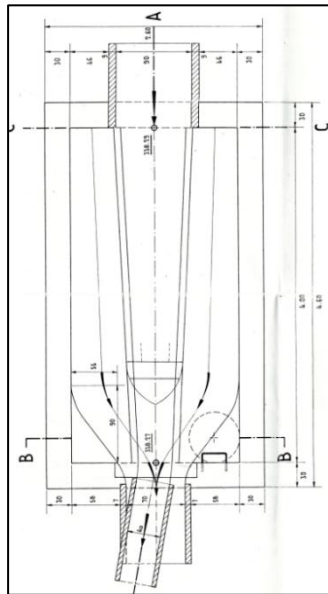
Grundriss und Übersicht RU 2 Schwimmbad Brugg
